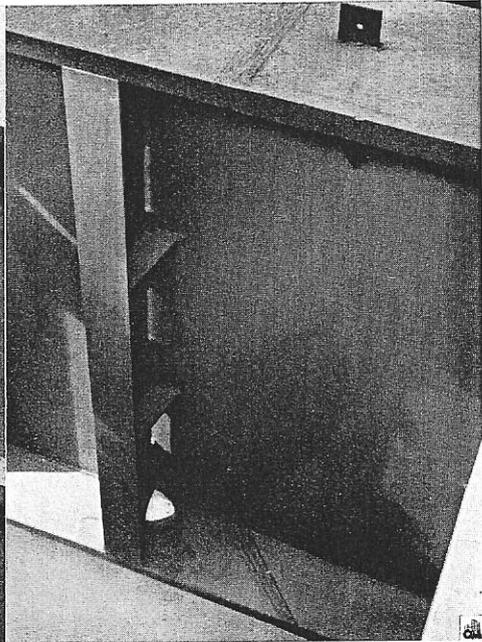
Entre les cadres du contreventement on a placé des raidisseurs en forme de T constitués par des tôles et des plats.
